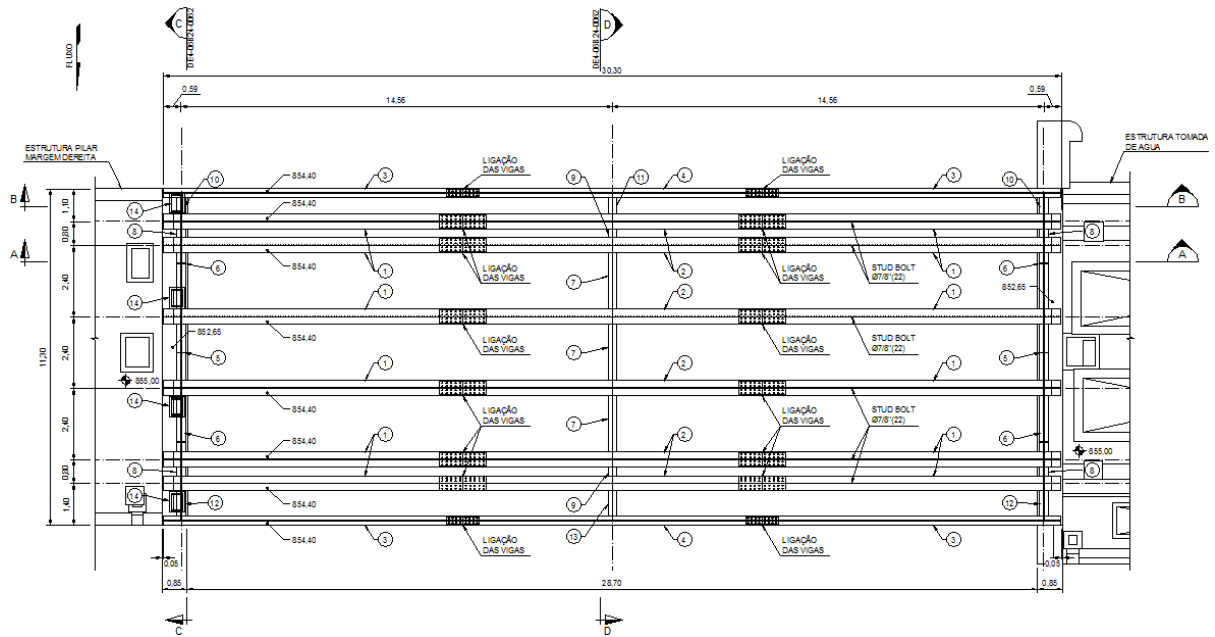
Puente de acceso – Planta (Intertechne, 2015)
